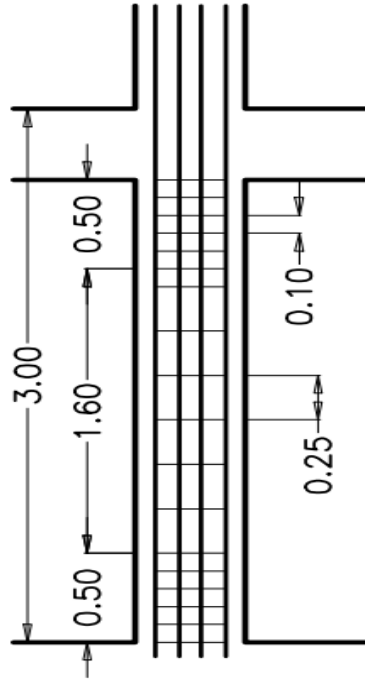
Distribución de acero longitudinal Columna 45 x 45 cm
